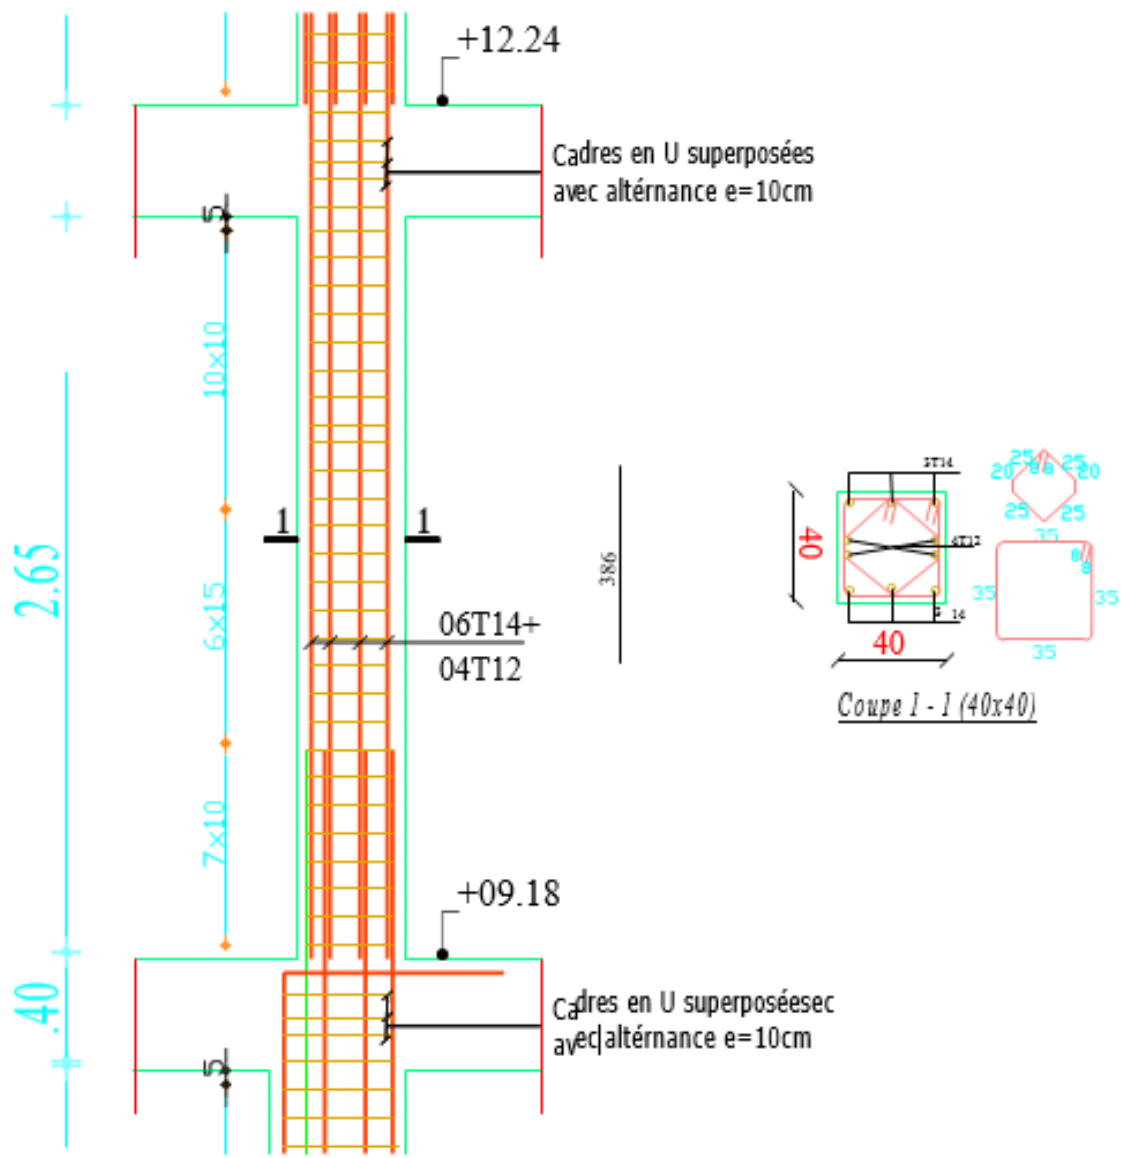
ferrailage de poteaux (4^{ème}, 5^{ème}, 6^{ème})
